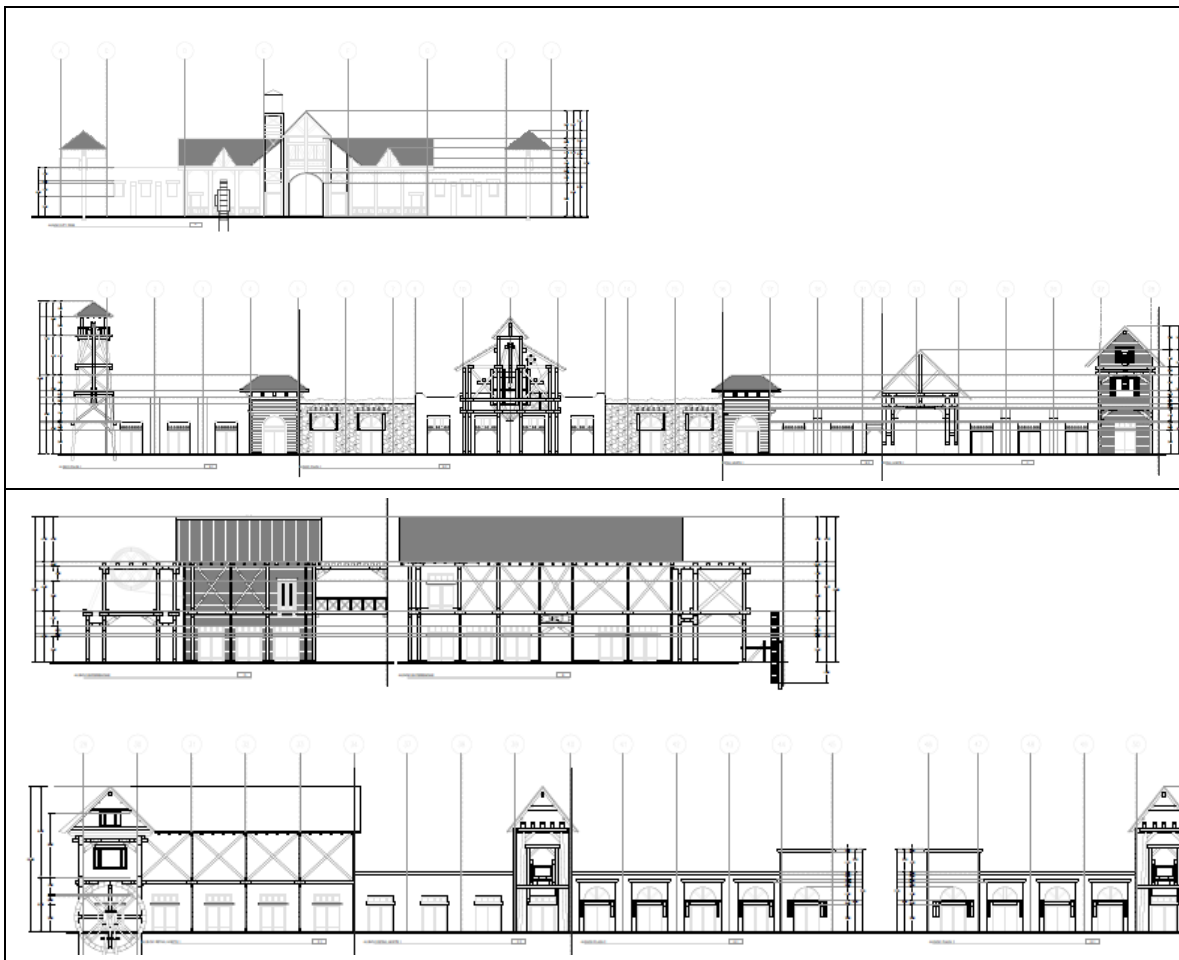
Diseño arquitectónico (plano alzado) de los cobertizos 1 y 2.
